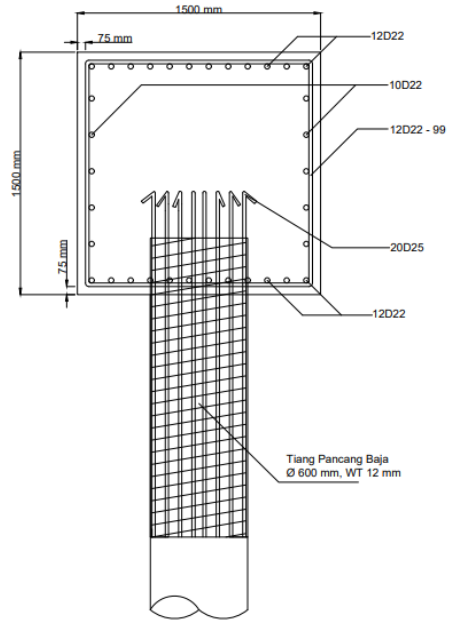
Desain Penulangan *Pile Cap* Balok Dermaga
